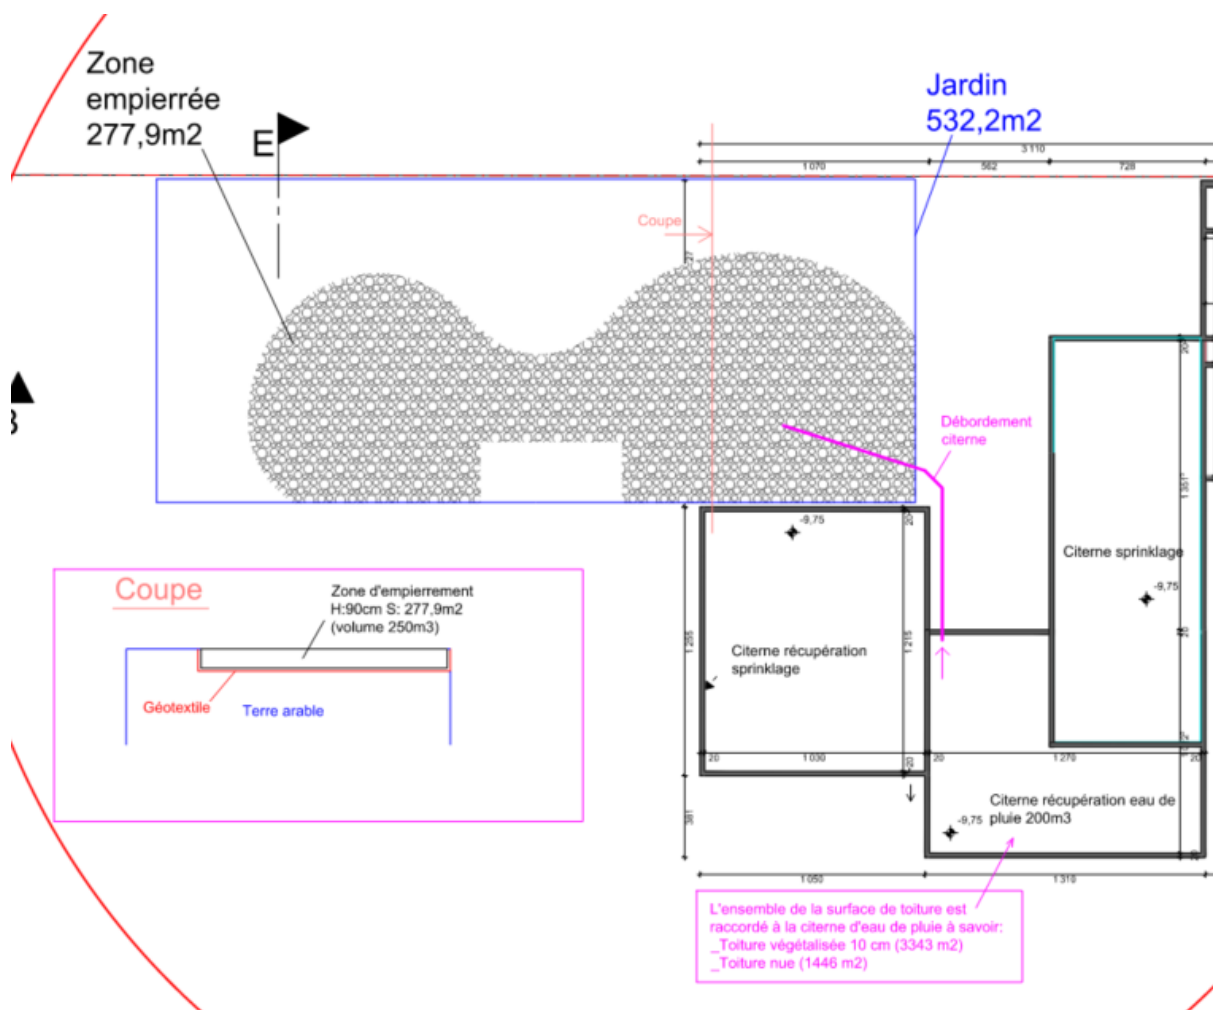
Ouvrages d'infiltration (source : Architectes et TPF Engineering)
